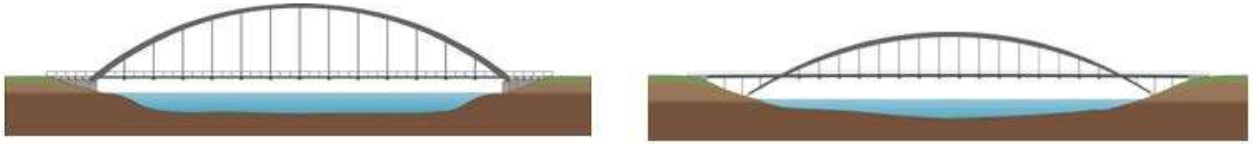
b Puente de tablero inferior y puente de tablero intermedio.
